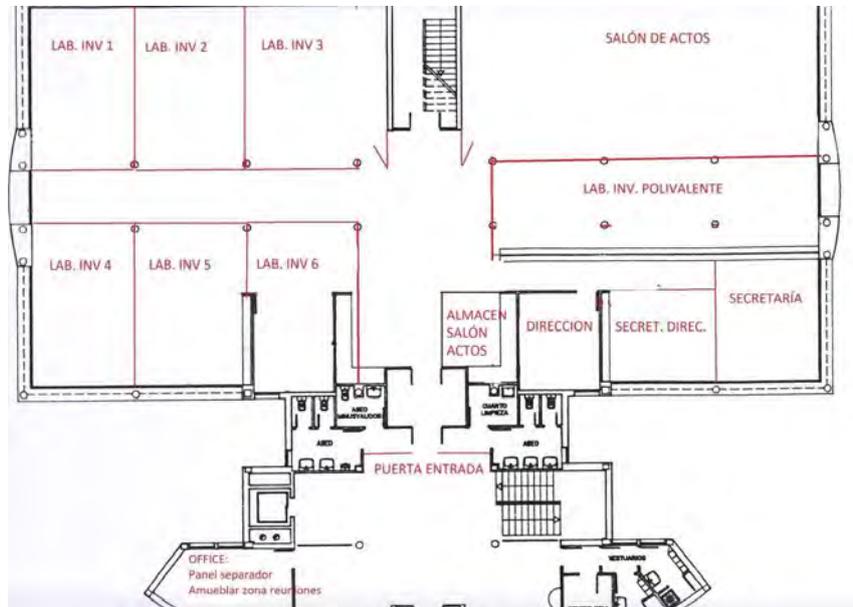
Mejora propuesta de espacios en la EUPT - Planta baja
